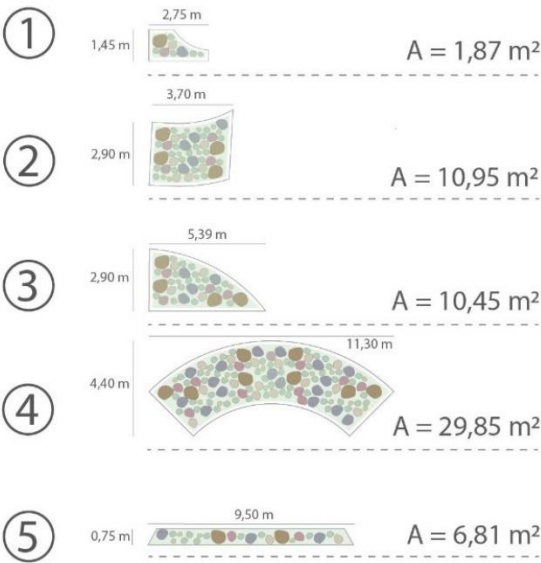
Vista geral de uma intersecção viária e tipologias de canteiros pluviais propostos no loteamento.
